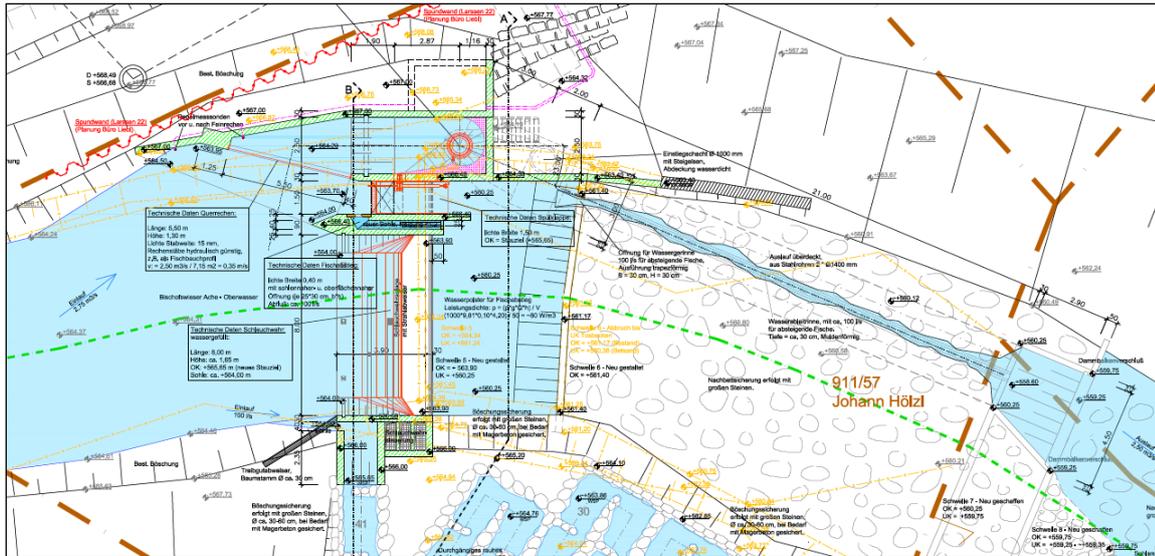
Lageplan WKA – Planung (Auszug Planung IB Ederer 2018)
